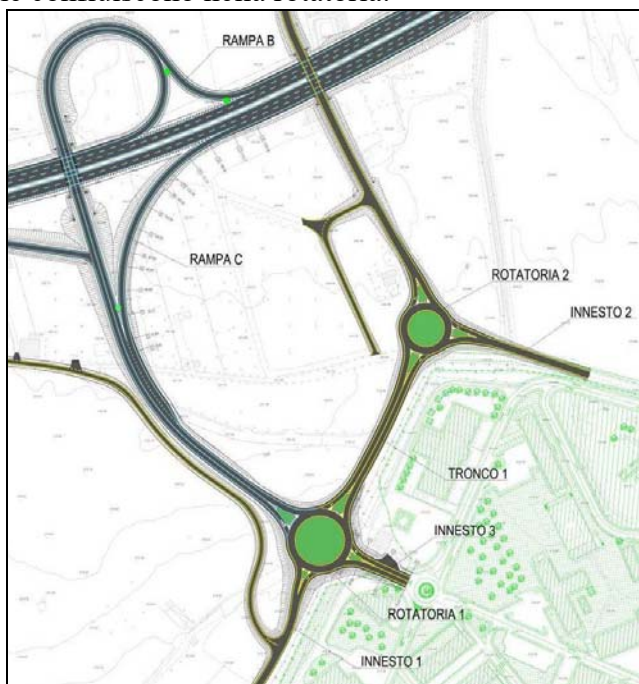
Stralcio planimetrico dell'area d'intervento
